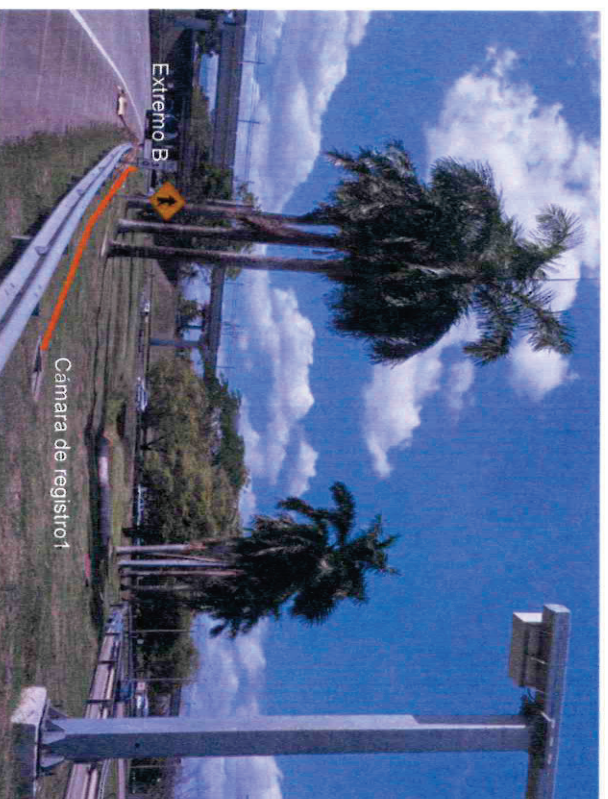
Línea naranja con la posible ruta del viga ducto2 entre cámara de registro1 hasta extremo A antes de la zanja pluvial.
